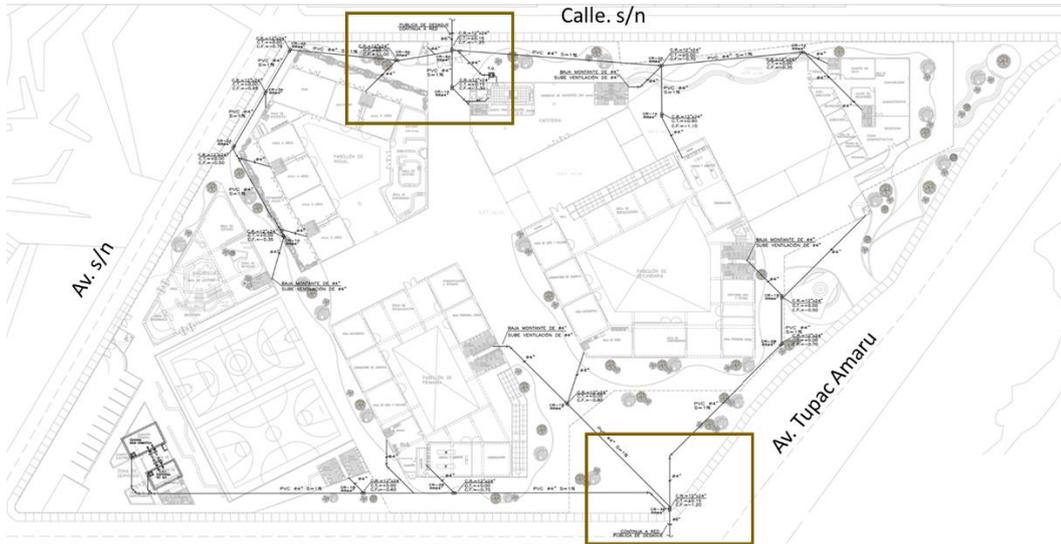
Desagüe, planta del primer nivel. Elaboración propia.
